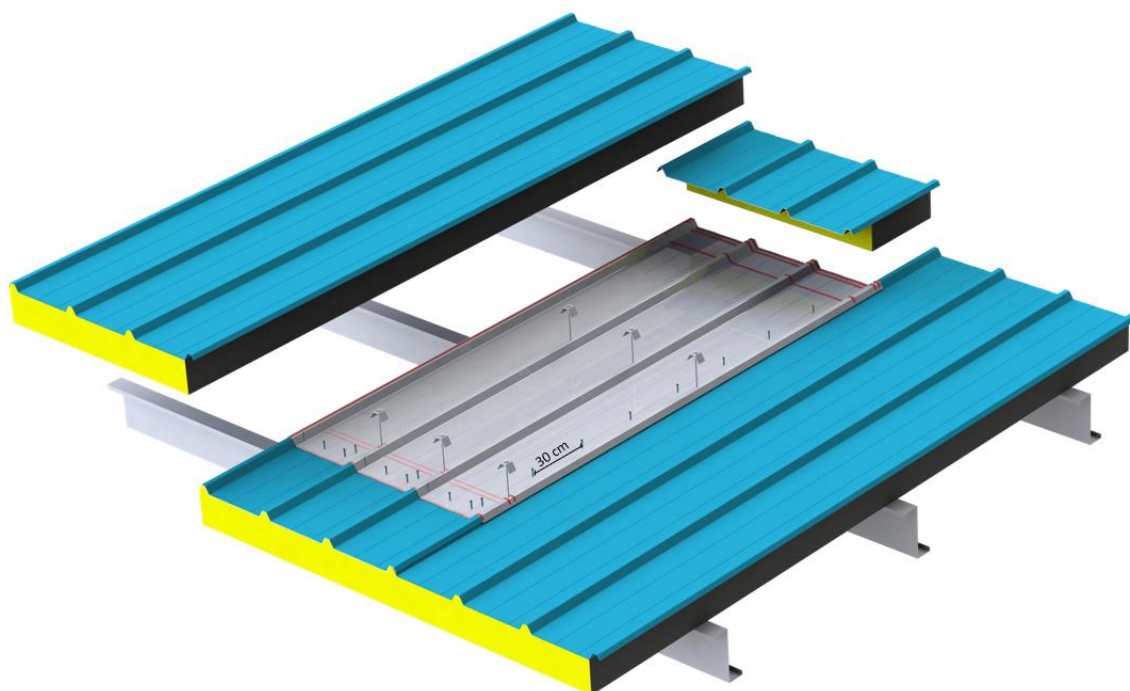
Etap nr 1 – Montaż profili dystansowych do konstrukcji dachu
